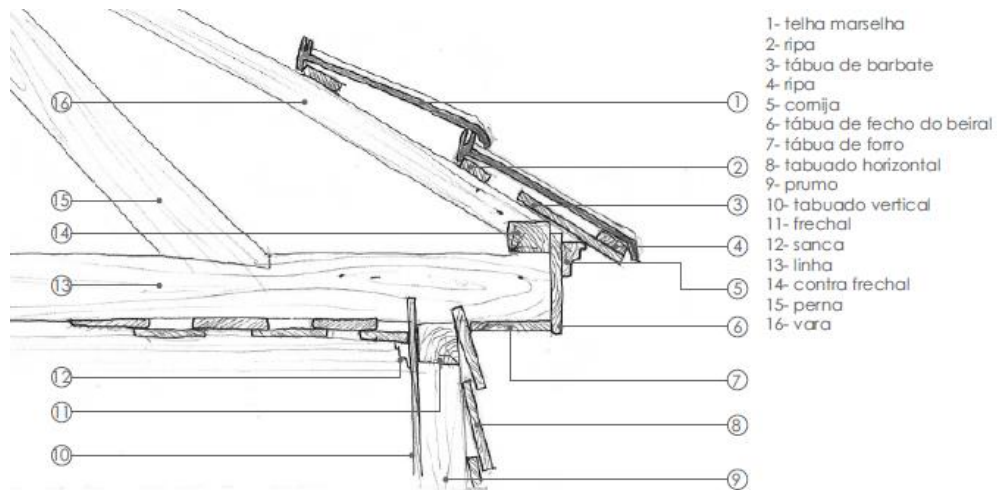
Pormenor tipo do beiral (fonte: Moutinho (2007))
